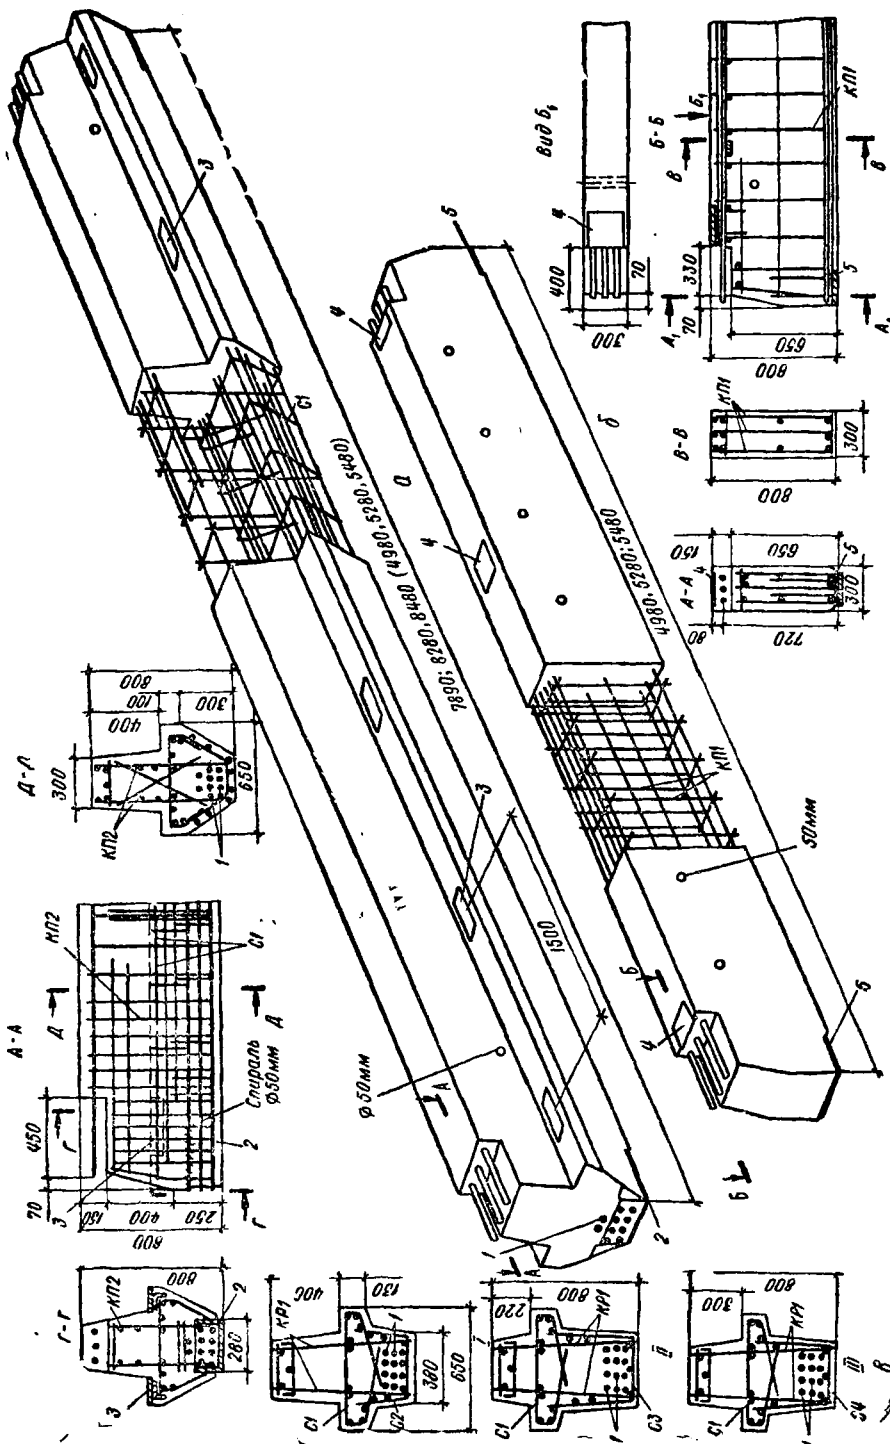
Ригелі перекриттів для будівель із рамними каркасами:
